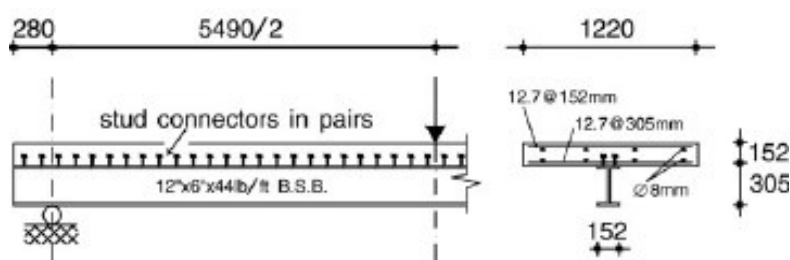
Layout da viga simplesmente apoiada, [Queiroz et al. \(2007\)](#)
